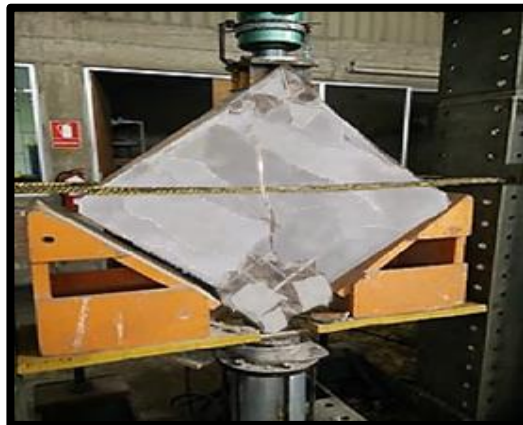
Murete de pirca colocada en la maquina sin reforzamiento
